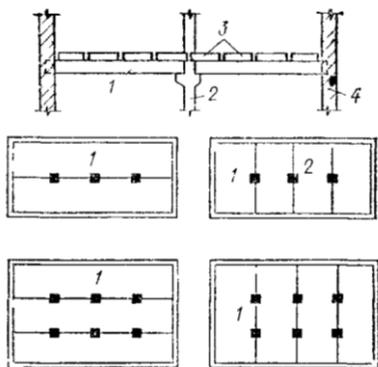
Схемы расположения сборных ригелей перекрытия
